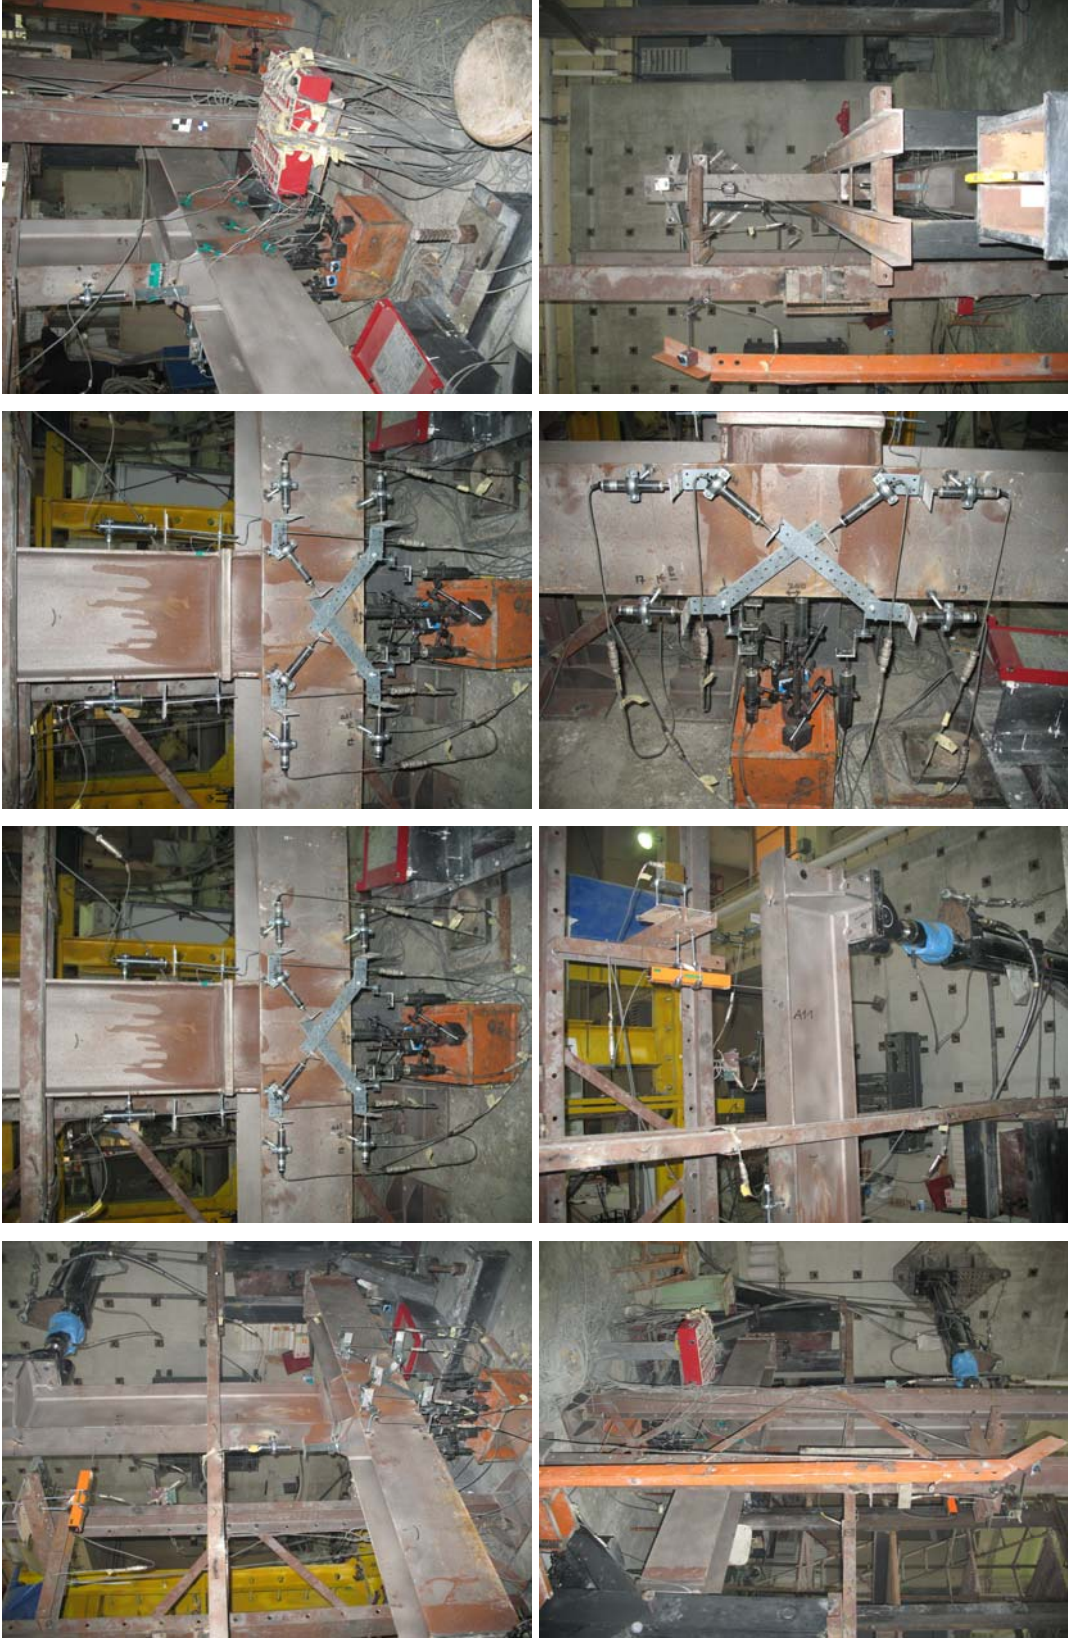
A2-1 grubu deney fotoğrafları. (Devam)
